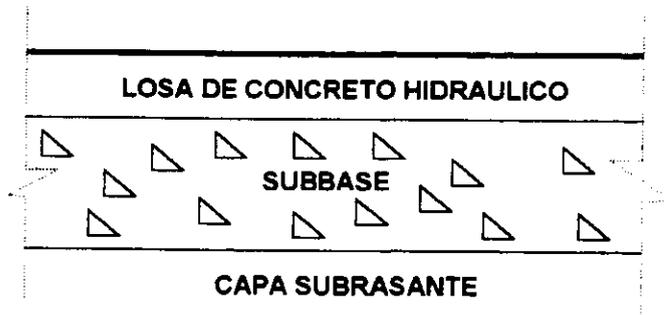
CAPAS QUE FORMAN UN PAVIMENTO RIGIDO
